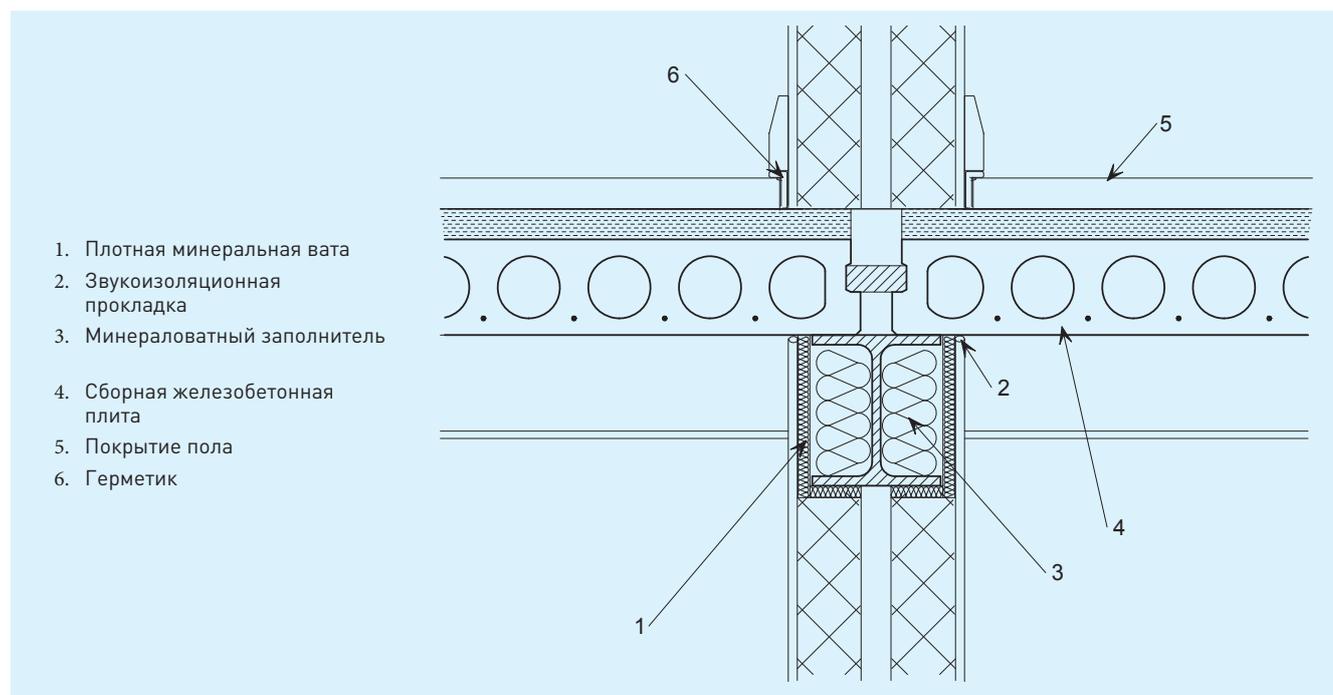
Типовая деталь примыкания внутренней перегородки к перекрытию
